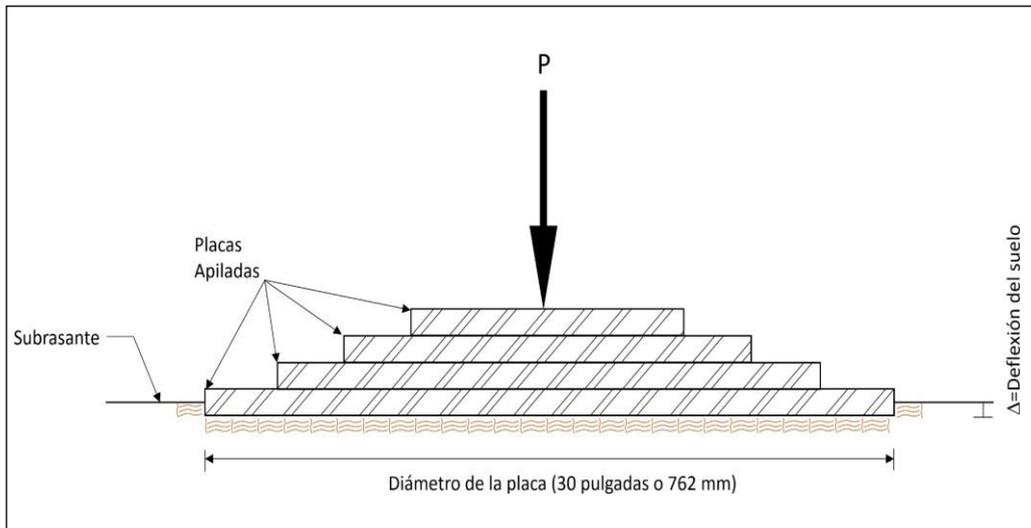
Esquema de ensayo de Placa de Carga - ASTM D1196
